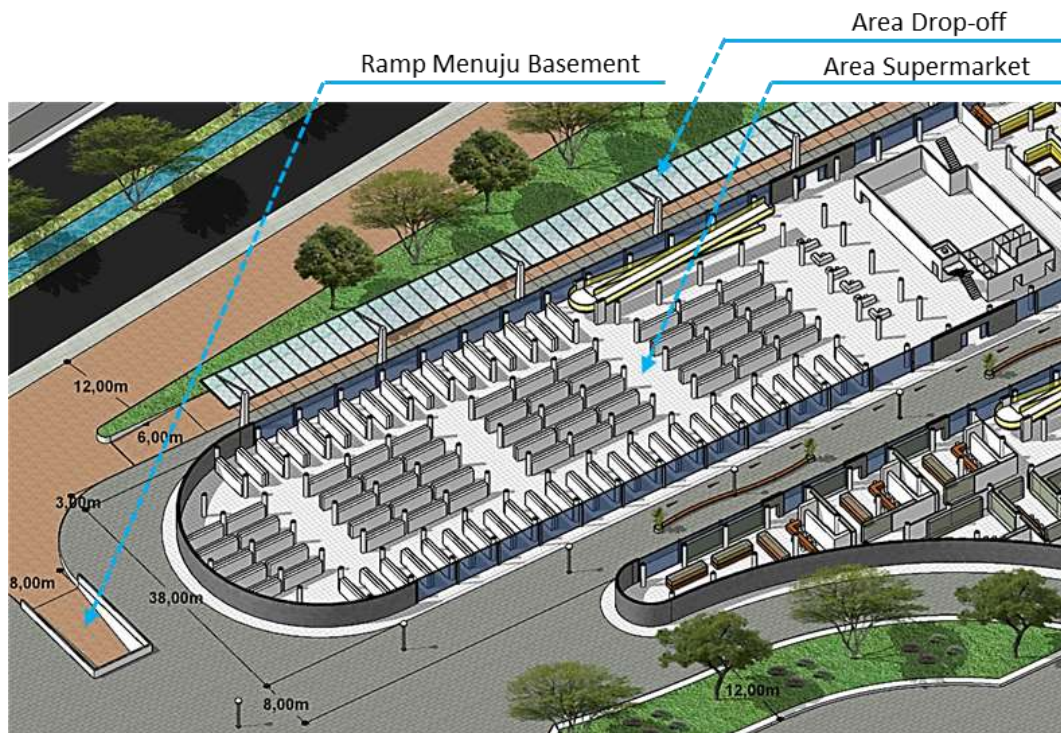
14 Site Plan Kompleks Bangunan dan Lingkungan Sekitar
